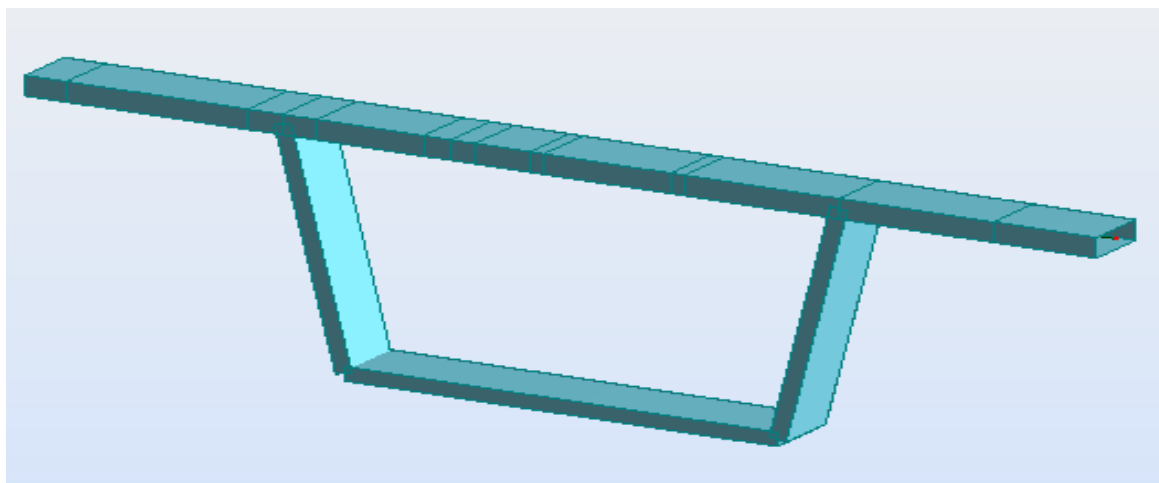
Modélisation de la section transversale (sur culée).
